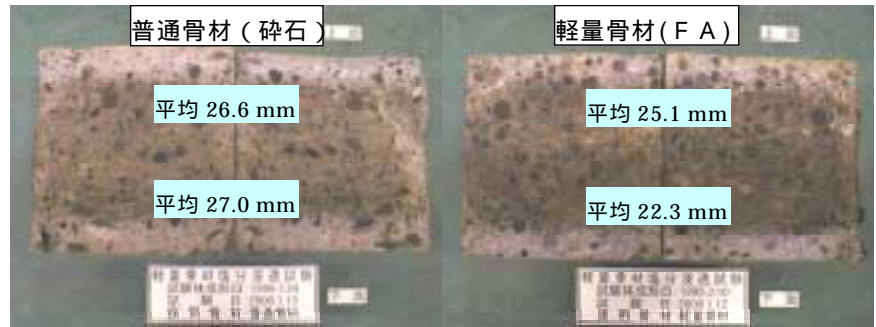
塩分浸透試験における浸透深さの測定結果の一例 (実験シリーズ 3) Measuring Examples for Salt Permeability Test of Concrete (Series 3)
